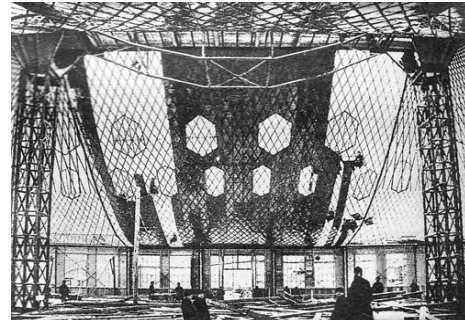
Конструкция висячего покрытия овального в плане павильона. 1896г
